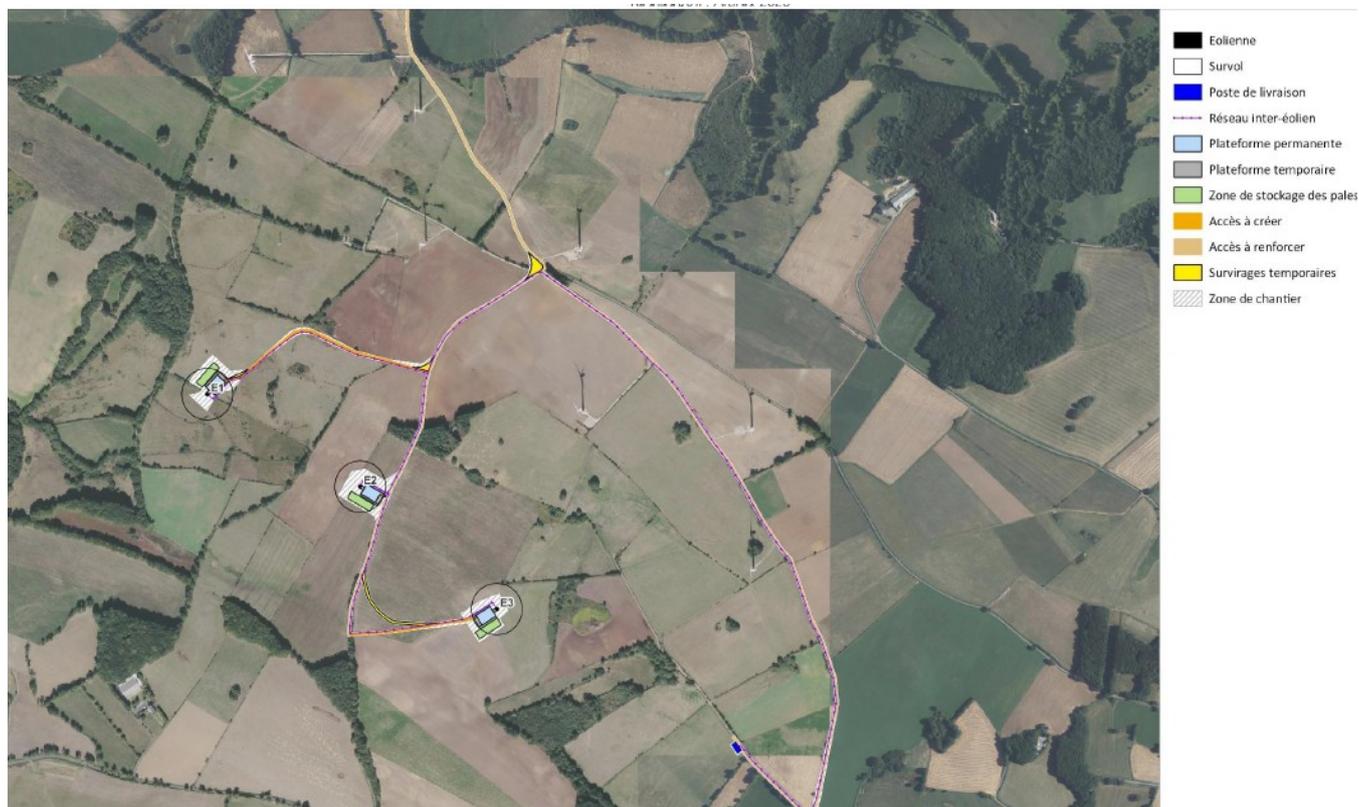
plan de masse – source orthophotos et scan 100 IGN
